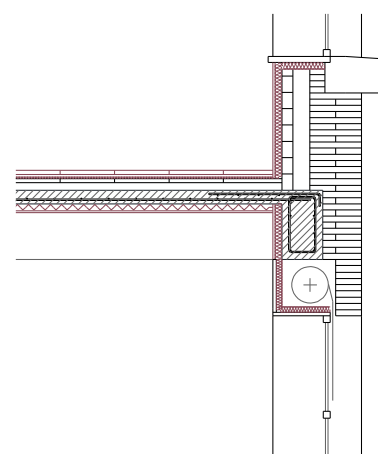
Aislamiento en los capialzados y alféizares de las ventanas.
